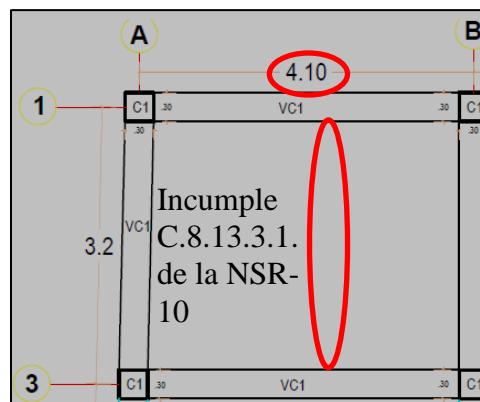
Error Planta losa Nervada en una dirección.
